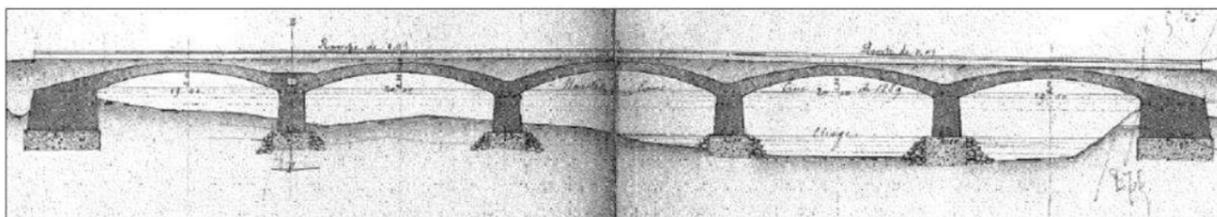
Vue en élévation de l'ouvrage (Extrait de plan d'époque)
